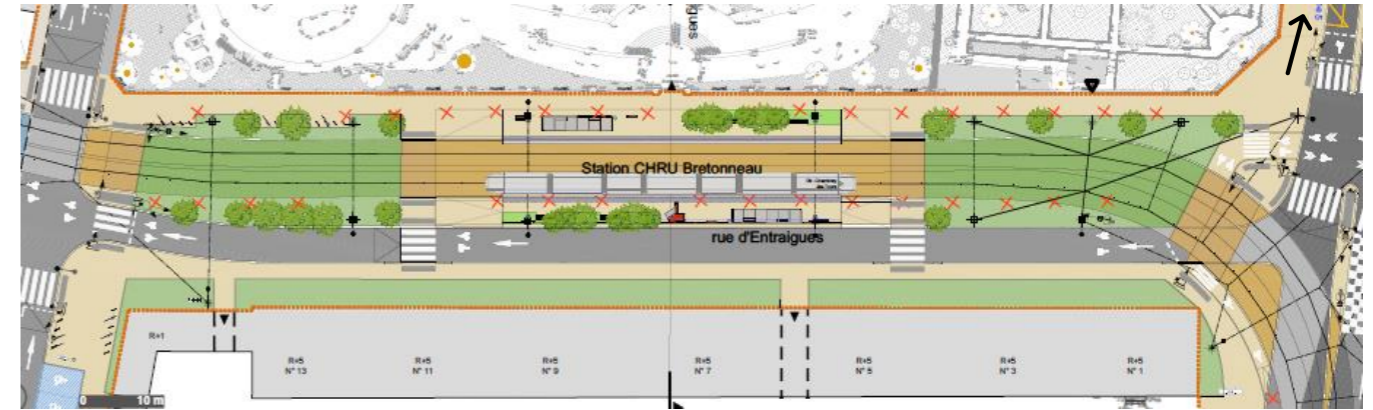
PLAN D'AMENAGEMENT AU NIVEAU DE LA STATION CHRU BRETONNEAU
